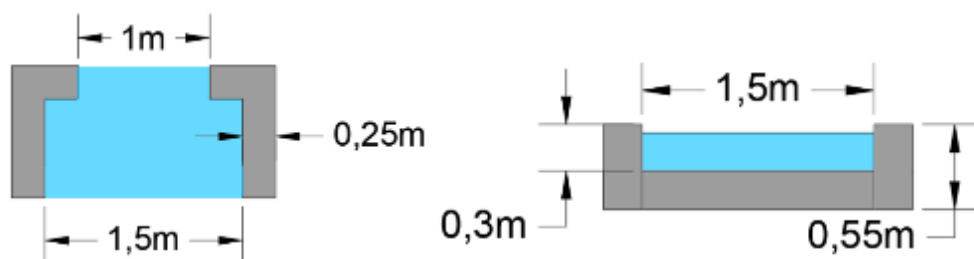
Detalls de la planta (esquerra) i de la secció transversal (dreta) de l'arqueta. Font: Pròpia
